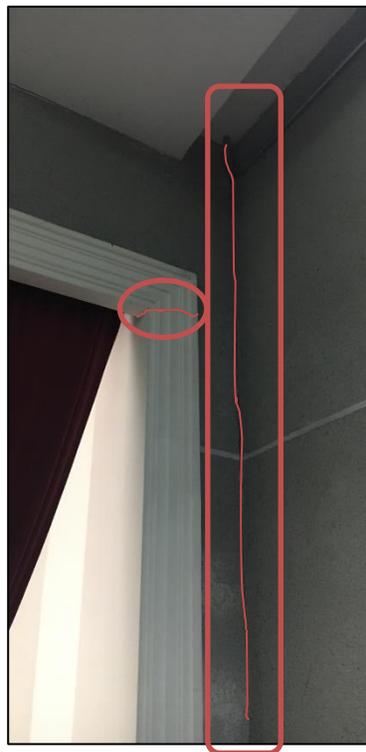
Teatro zona platea – Muros interiores fisurados.
